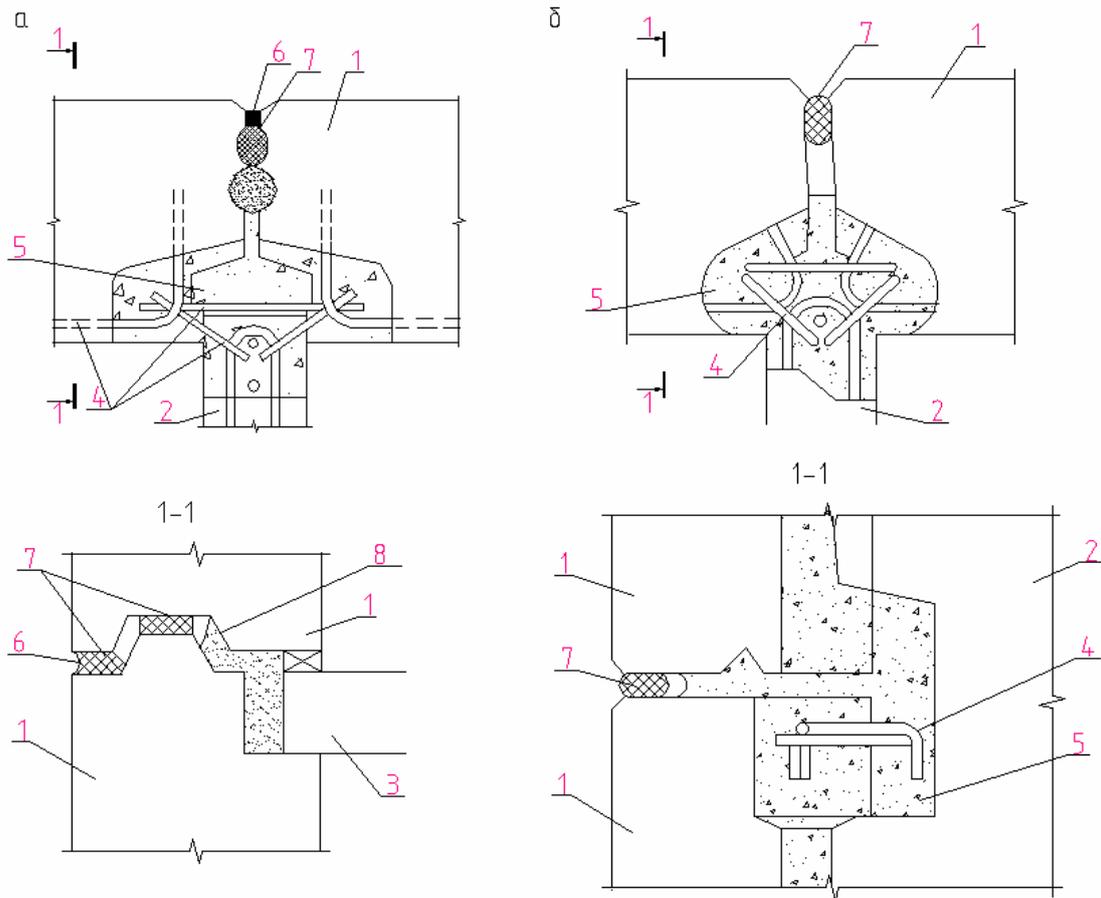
20. Схема герметизации панелей наружных стен крупнопанельных зданий: *а* – дома с узким шагом несущих поперечных стен; *б* – дома с продольными несущими стенами; 1 – панель наружной стены; 2 – панель внутренней стены; 3 – панель перекрытия; 4 – стальные связи; 5 – бетон; 6 – герметизирующая мастика; 7 – уплотнительная упругая прокладка; 8 – раствор
